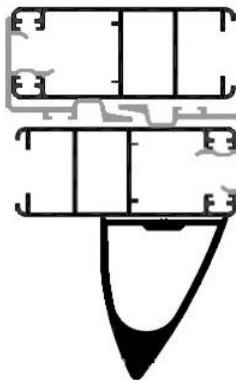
Parante Central Combinado mas perfil Refuerzo
